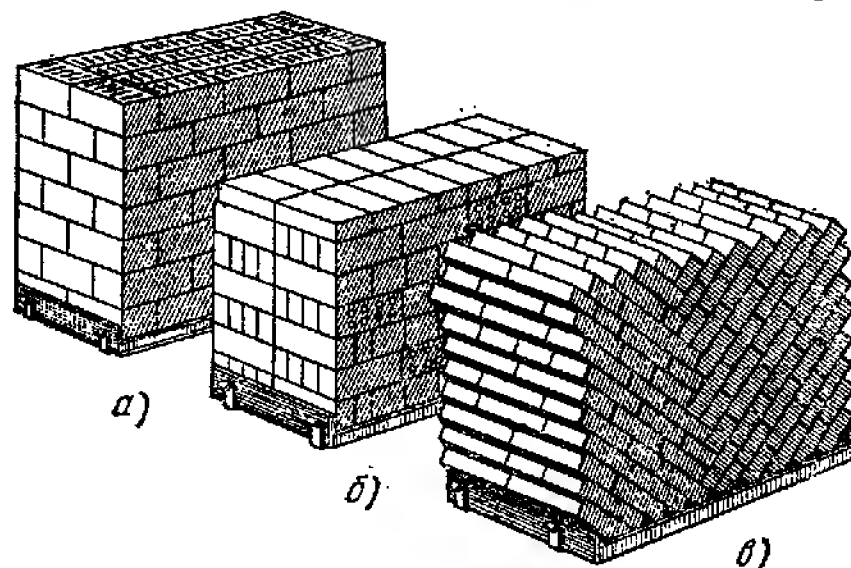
Укладка на поддонах кирпича с перевязкой:
